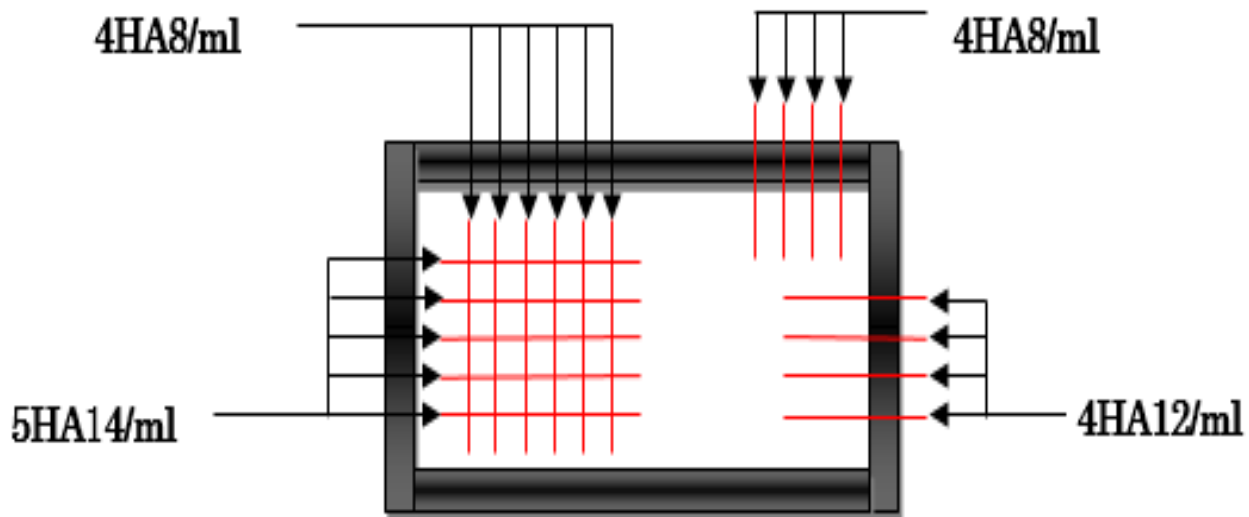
Schéma de ferrailage dalle pleine sur 4 appuis
